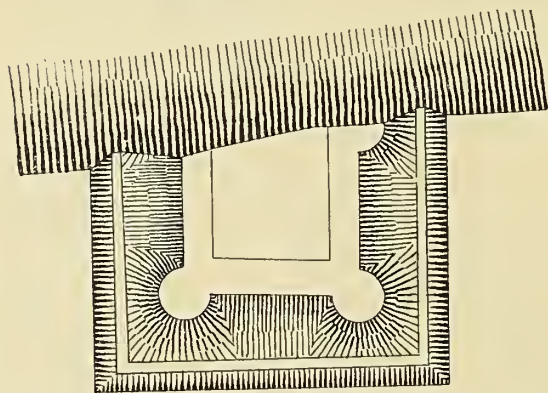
Grundriss einer alten Erdveste bei Balaton-szemes, genannt Bolondvár (= Irrenburg), westlich der mit einem hohen Turm verbundenen Villa. Der Plan stellt die Situation vor der Gründung der Villenkolonie dar. Masstab 1 : 250.
